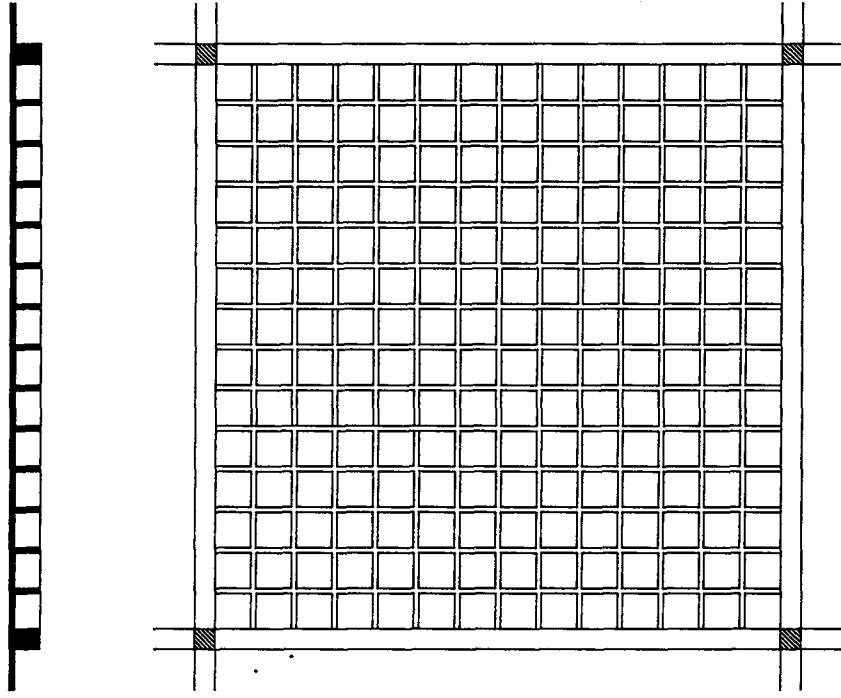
4. Nervürlü döşemenin plan ve kesiti.
